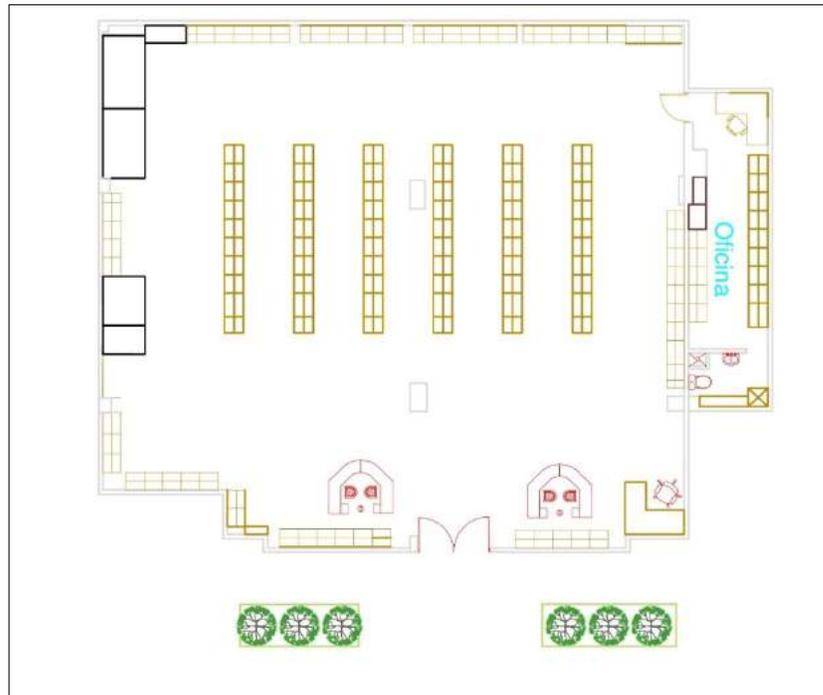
Plano Arquitectónico Supermercado Parque Condominio
